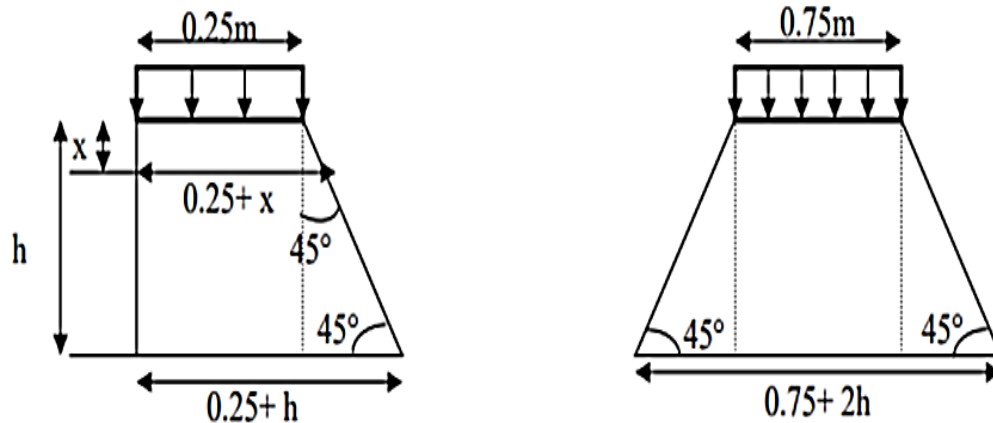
Poussée de la charge locale située en arrière du mur
